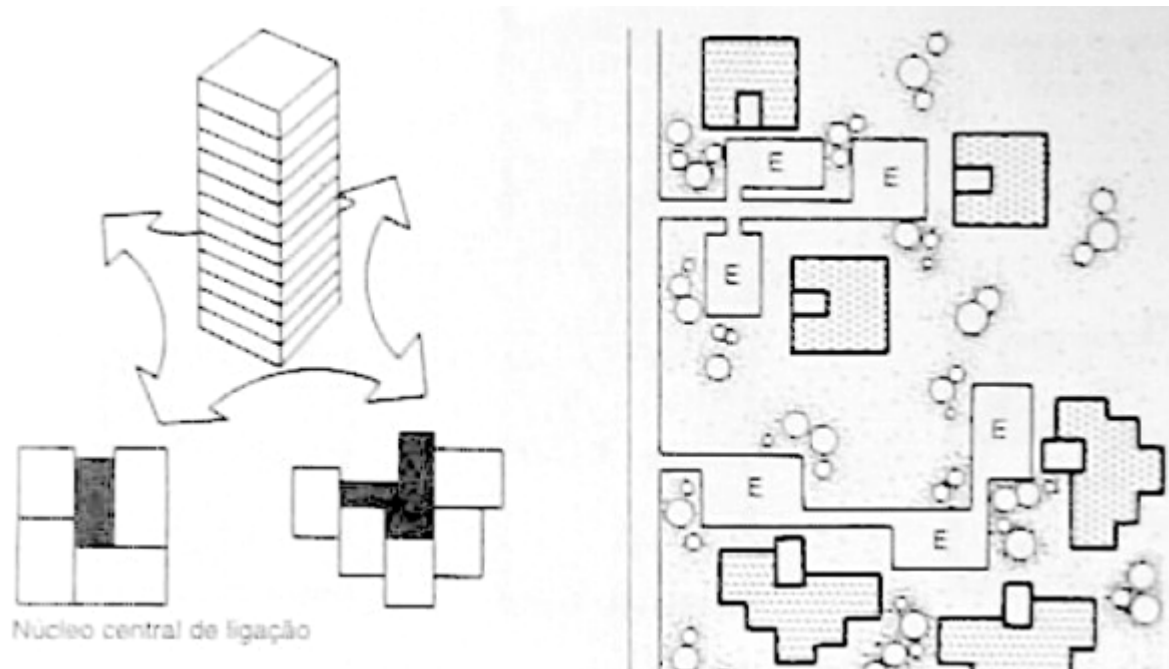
Perspectiva e esquemas de planta e implantação para a tipologia em torre.
